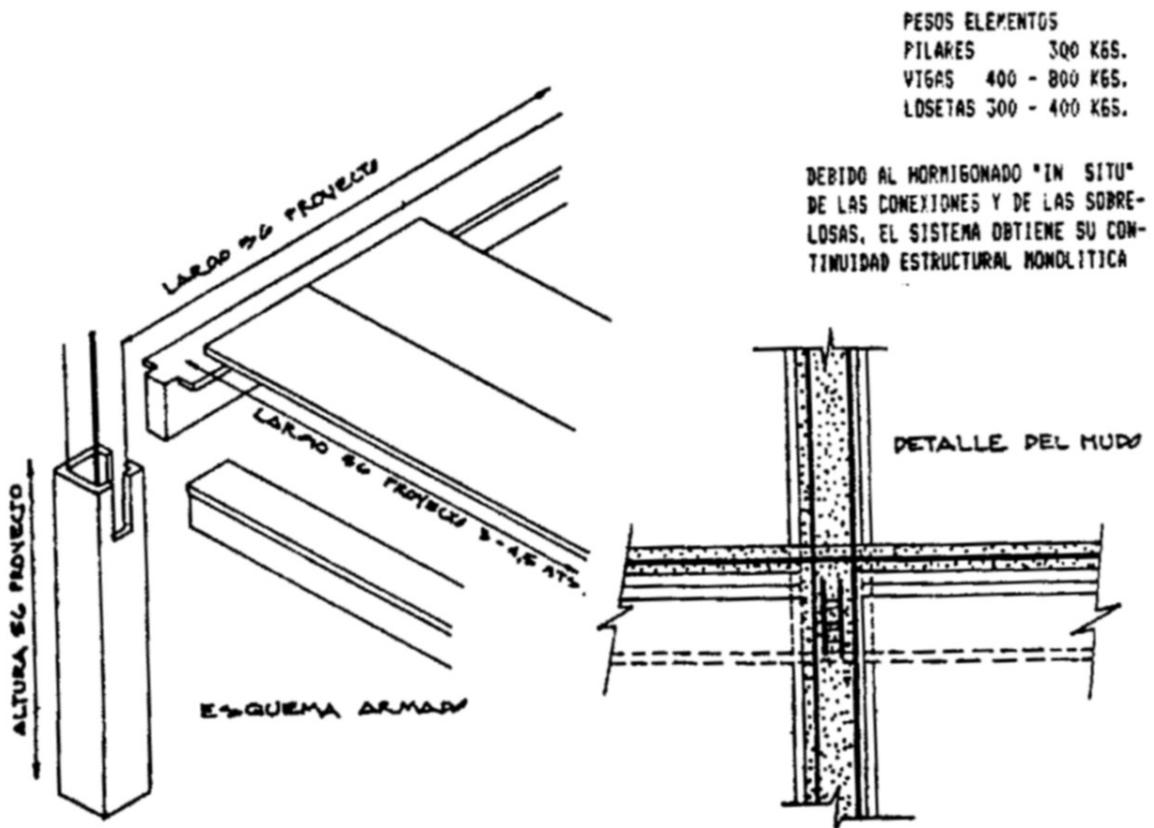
Detalles Constructivos del Sistema Structurapid-Depetris
